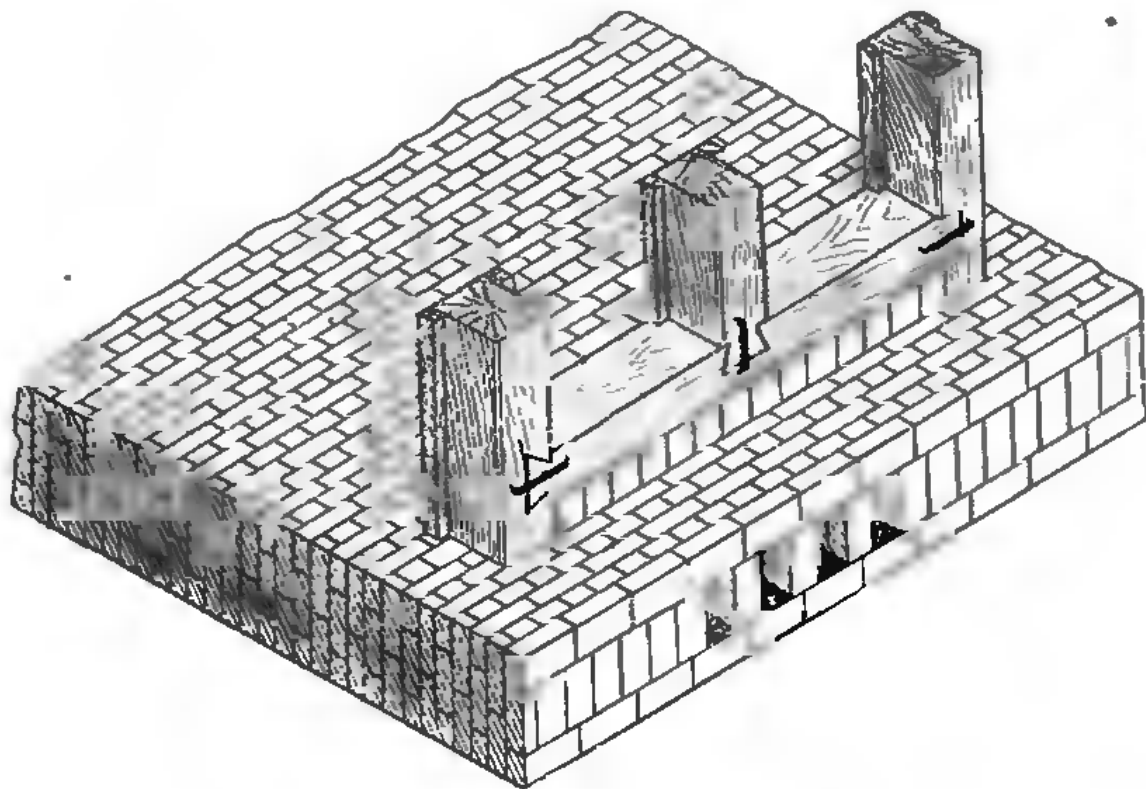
Устройство ригеля для опоры балок у дымовой трубы
